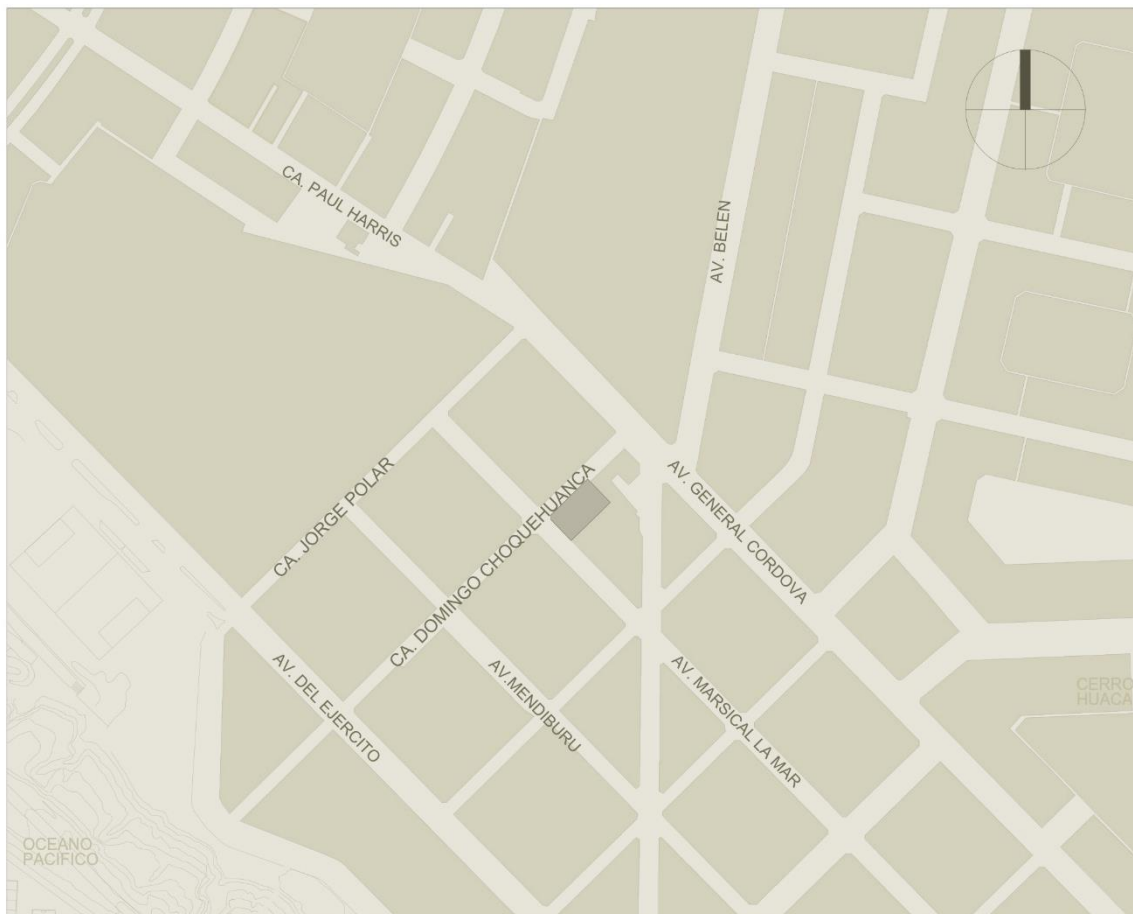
Plano de Ubicación Multifamiliar Brissa 4112
